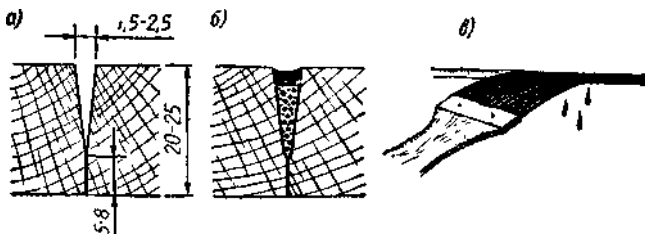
Разделка паза: *а* — подготовка паза; *б* — законченный паз; *в* — окраска паза
